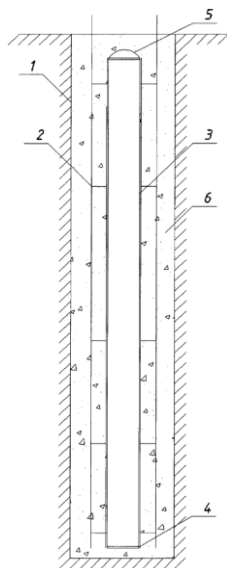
Конструкция буронабивной сваи-оболочки, где 1 - скважина; 2 - арматурный каркас; 3 - труба из полиэтилена низкого давления (ПНД); 4 - плоская пластиковая крышка; 5 - выпуклая пластиковая крышка; 6 - железобетонный ствол.
